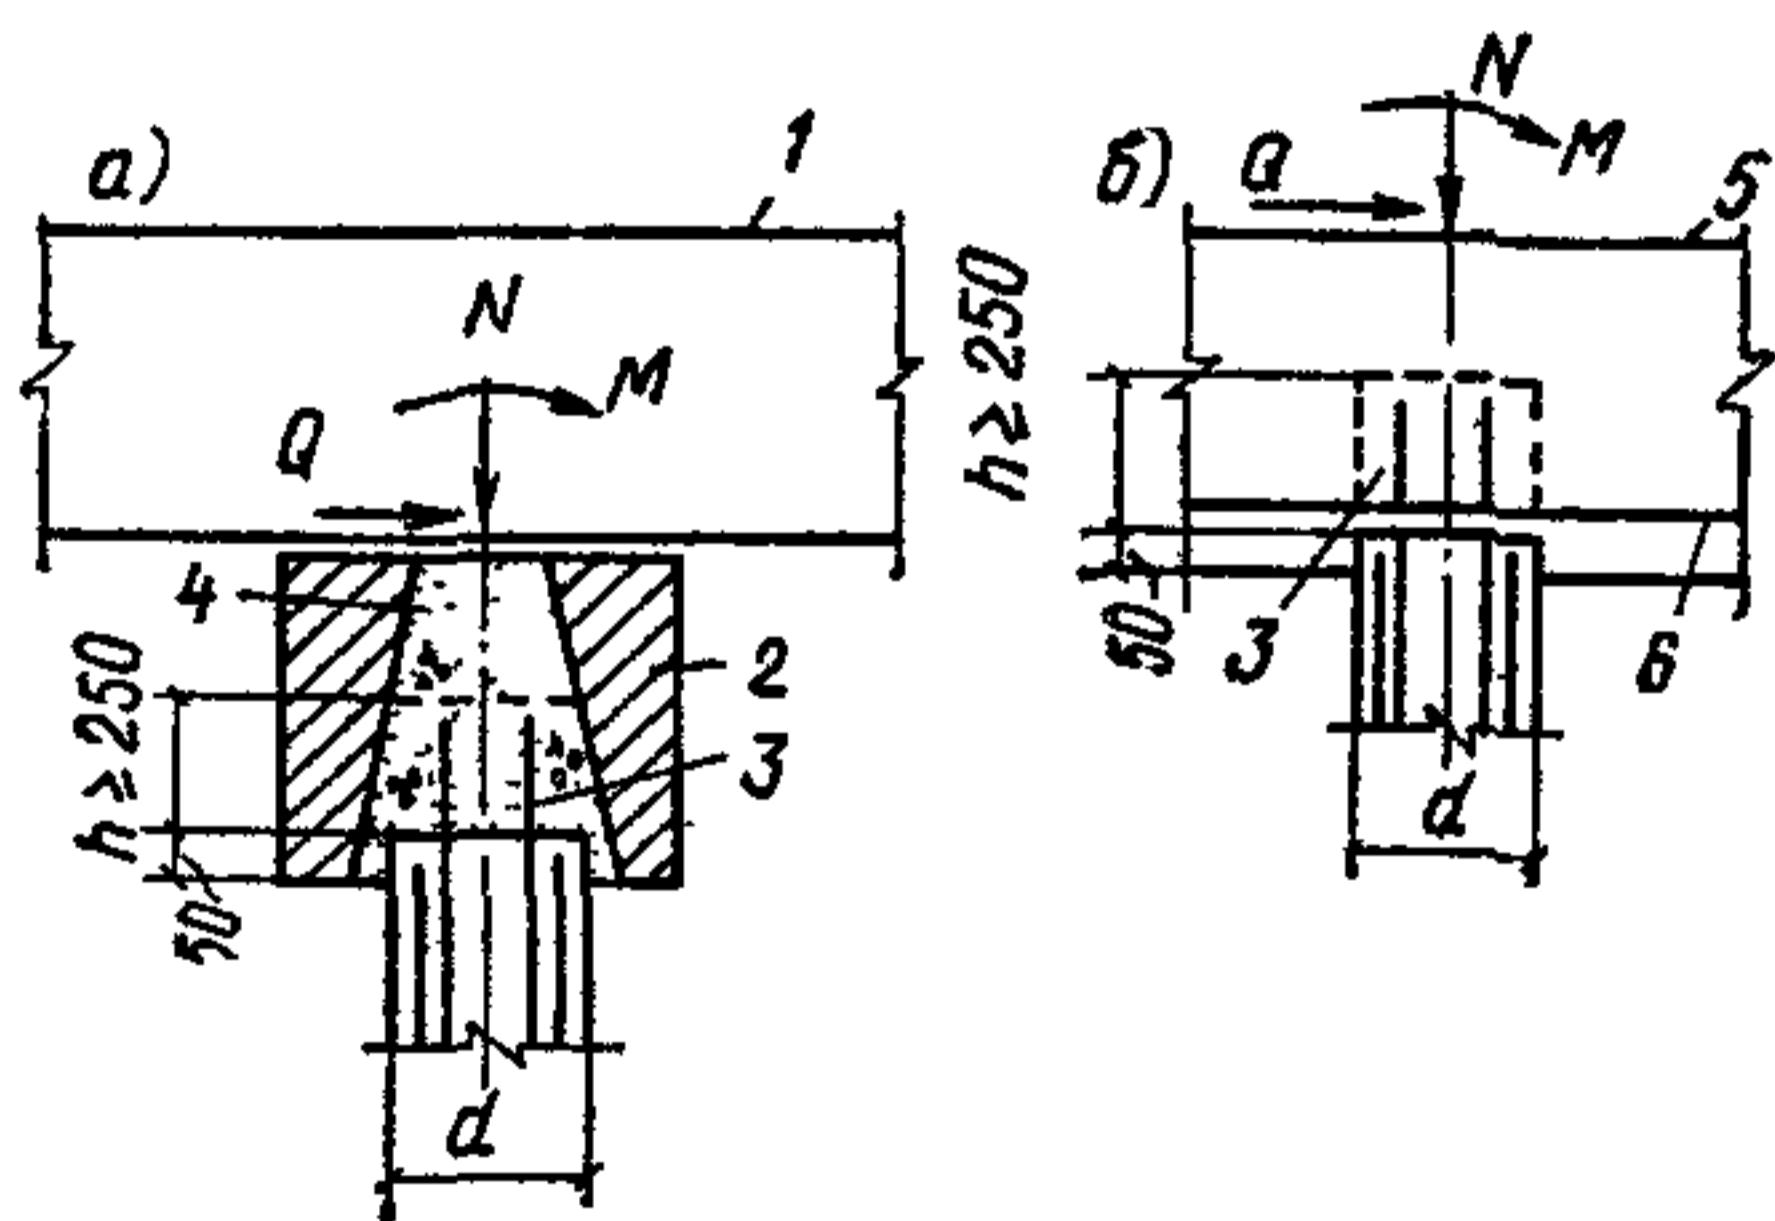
Пример конструктивного решения сопряжений железобетонных свай с предварительно-напряженной арматурой, работающих на вертикальные сжимающие и поперечные усилия и моменты, а также на внецентренные сжимающие нагрузки, выходящие за пределы ядра сечения свай, с ростверком
